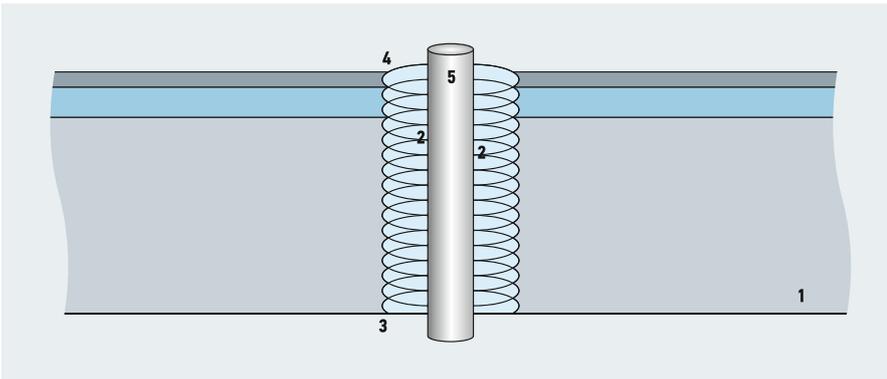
Провод полипропиленовых трубопроводов через перекрытия (1 — перекрытие; 2 — минеральная изоляция требуемой степени огнестойкости; 3 — штукатурка; 4 — силиконовая замазка; 5 — стояк)
